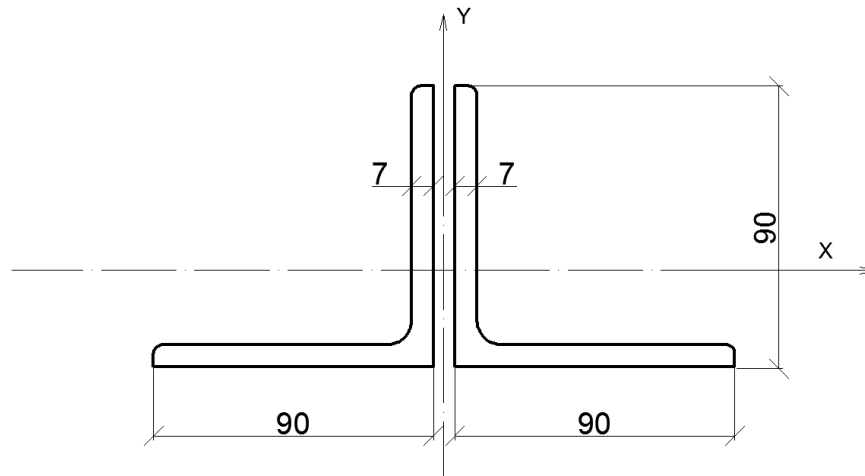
Фактическое поперечное сечение нижнего пояса стропильной фермы
